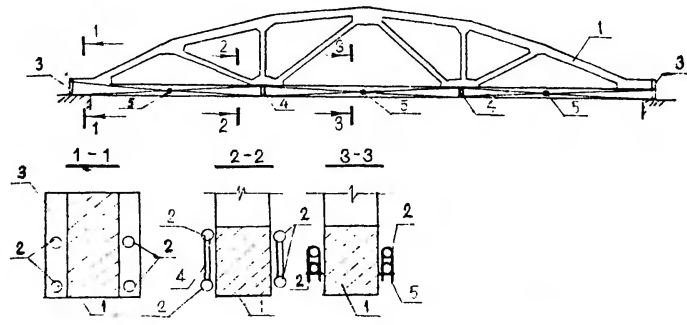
Усиление нижнего пояса постановкой предварительно напряженной затяжки из арматурной стали
